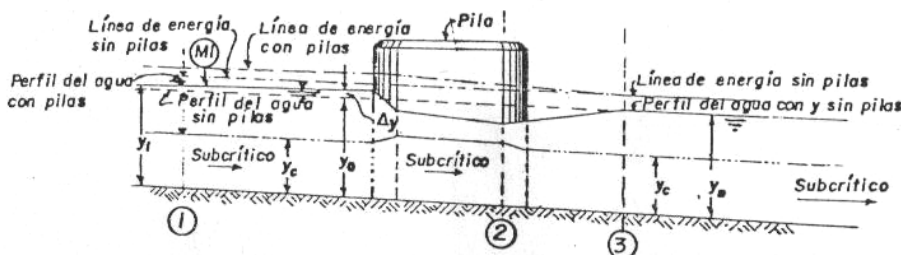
b Elevación de pilas para un flujo subcrítico. Tipo I
